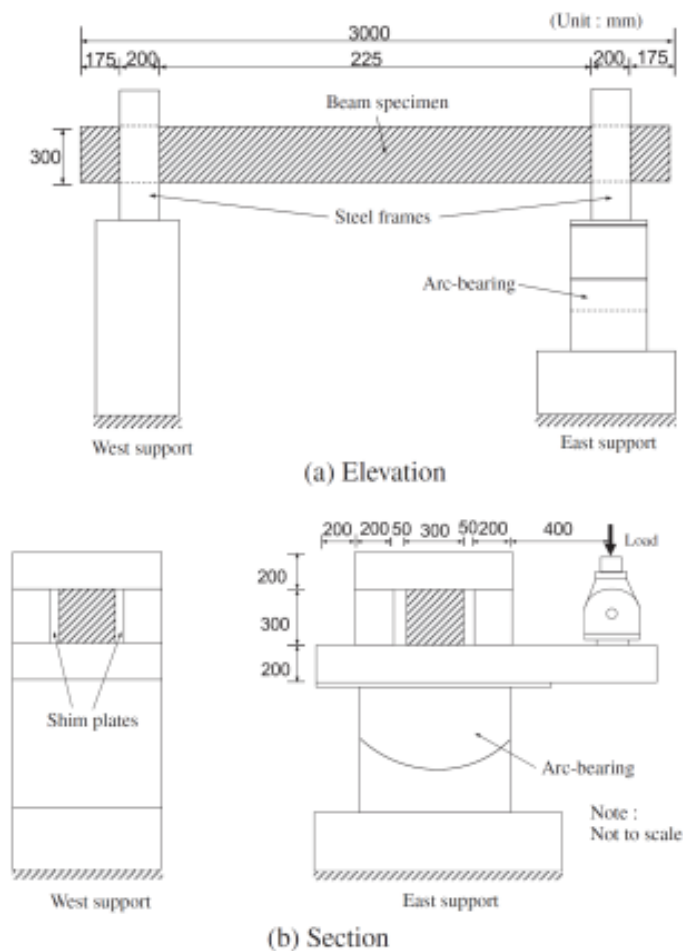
Detalhes da configuração do teste das vigas [2]
